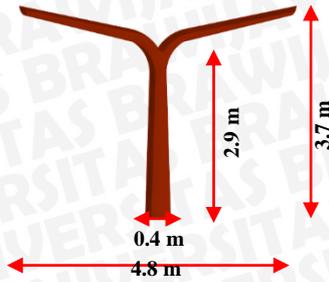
Peletakan kolom baja bangunan Stasiun Jember.
